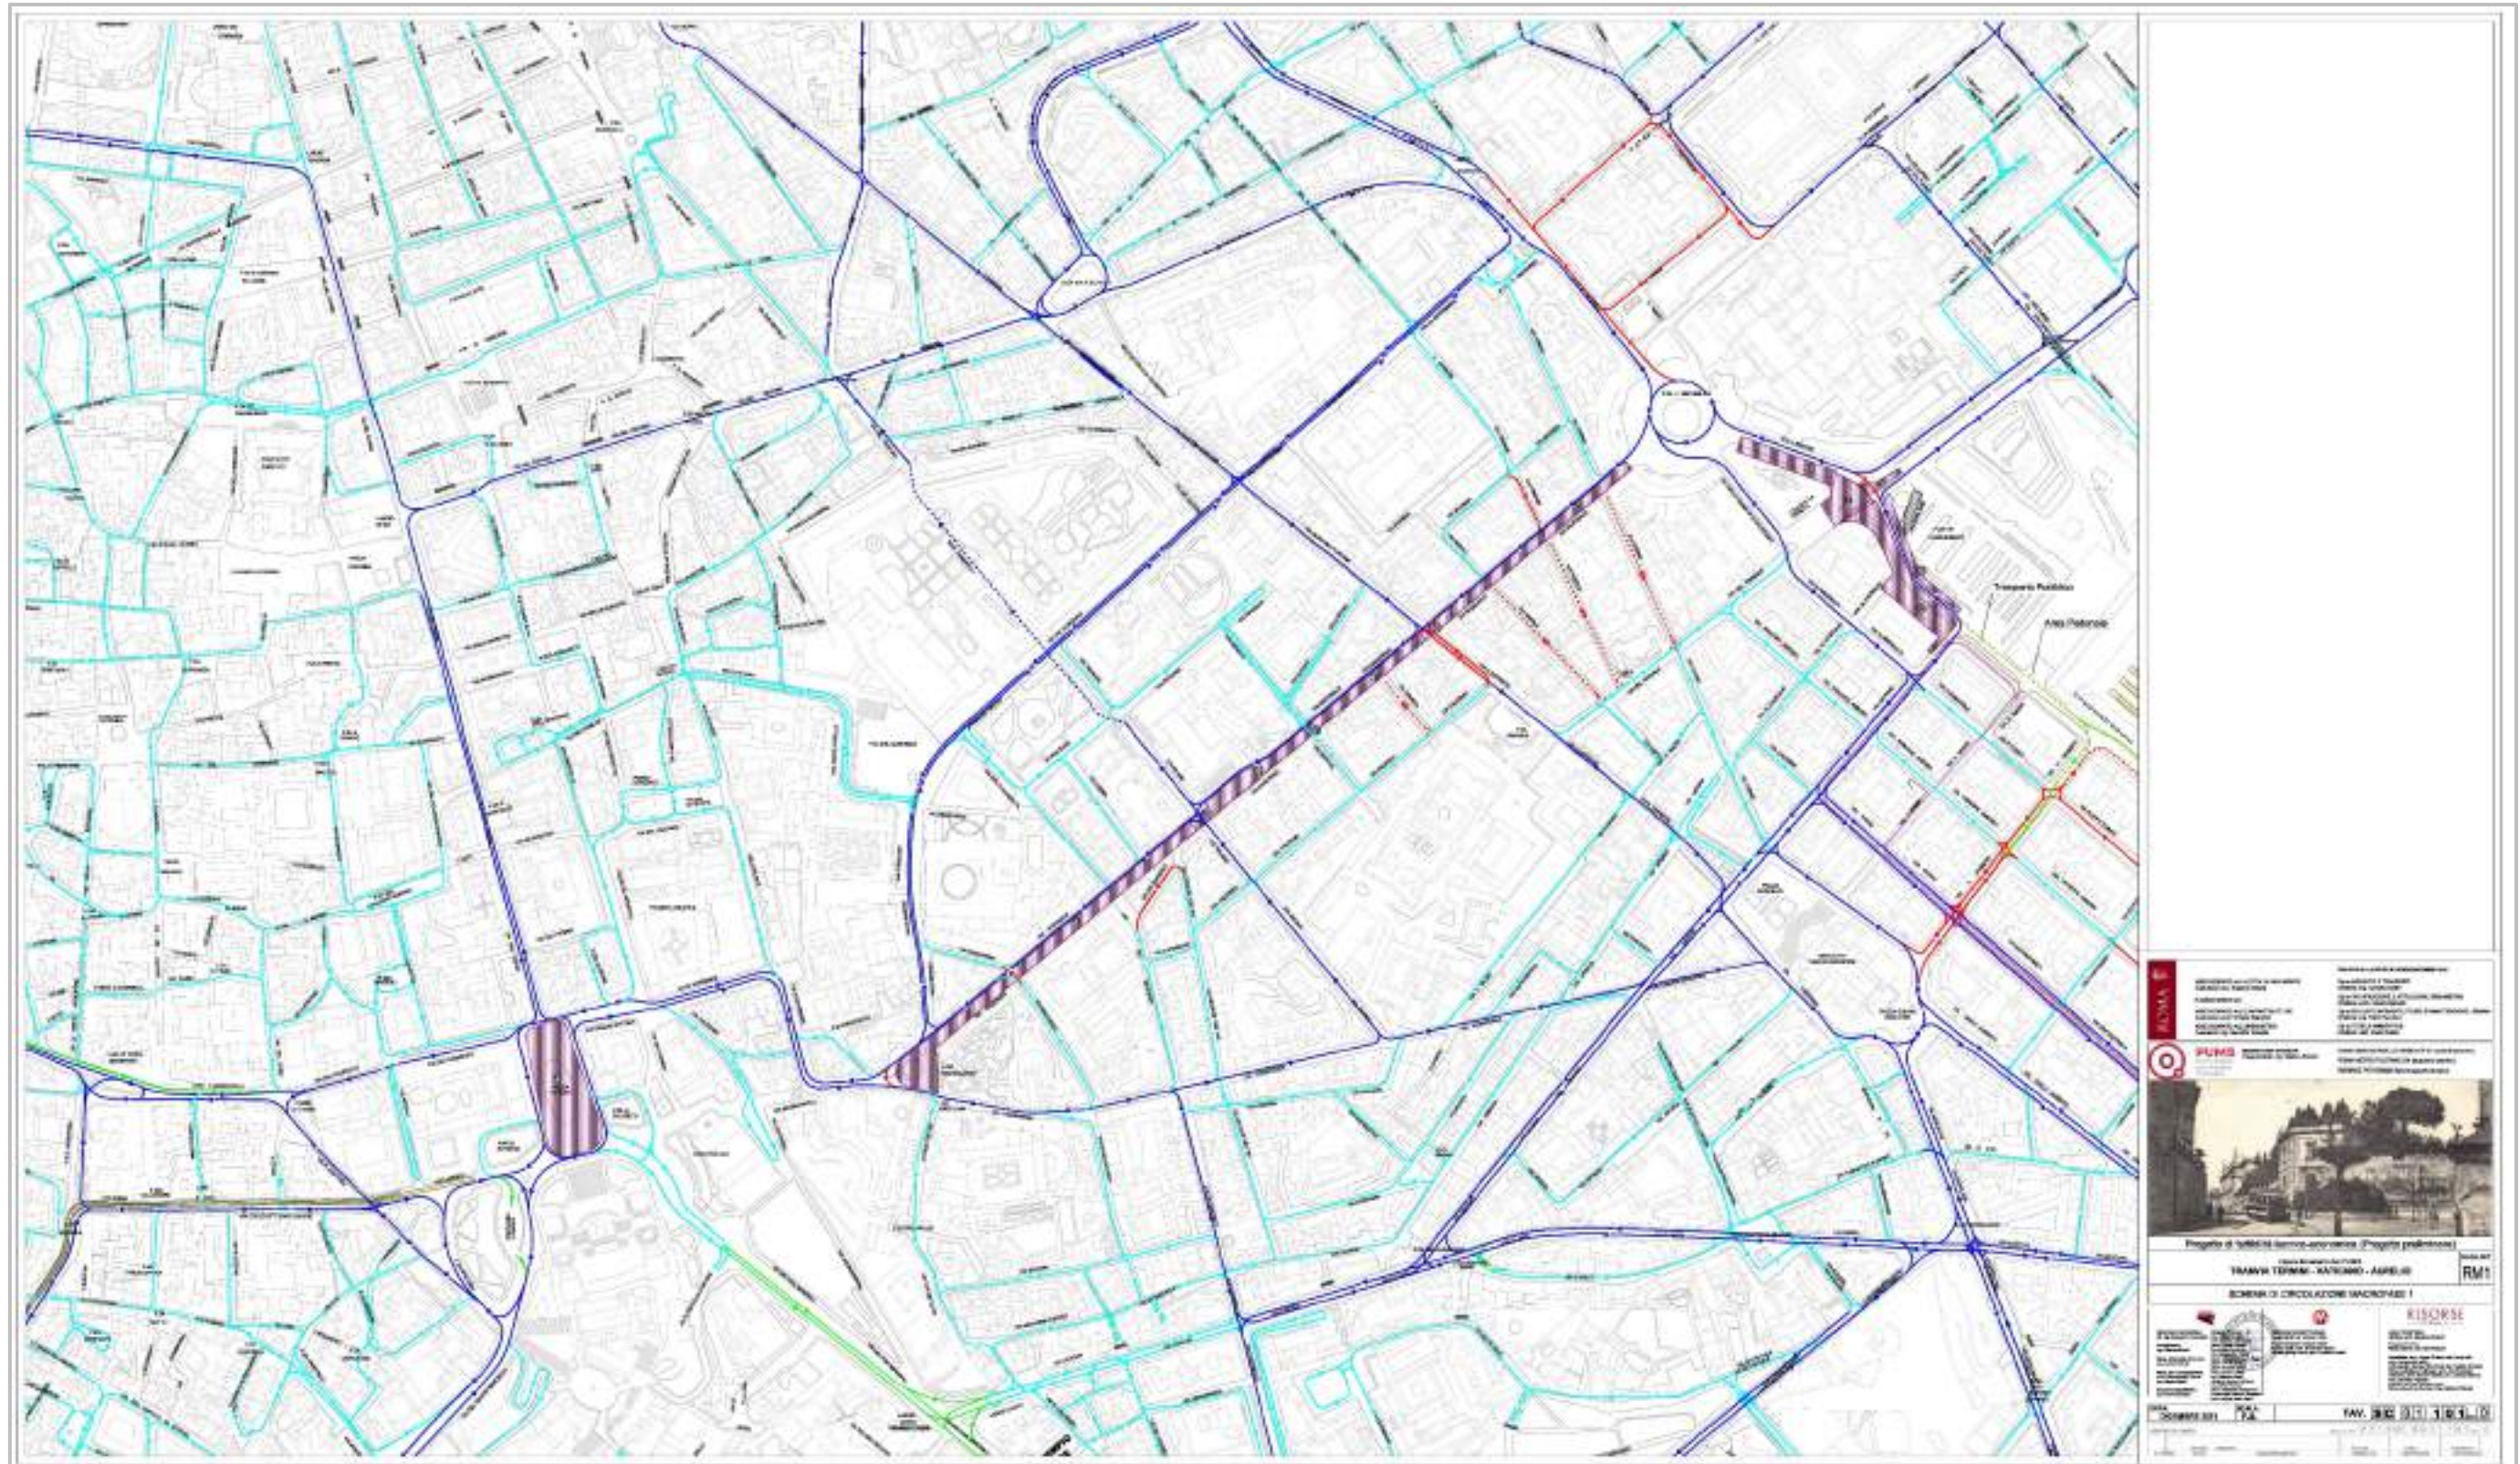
Schema circolazione di cantiere Macrofase 1
